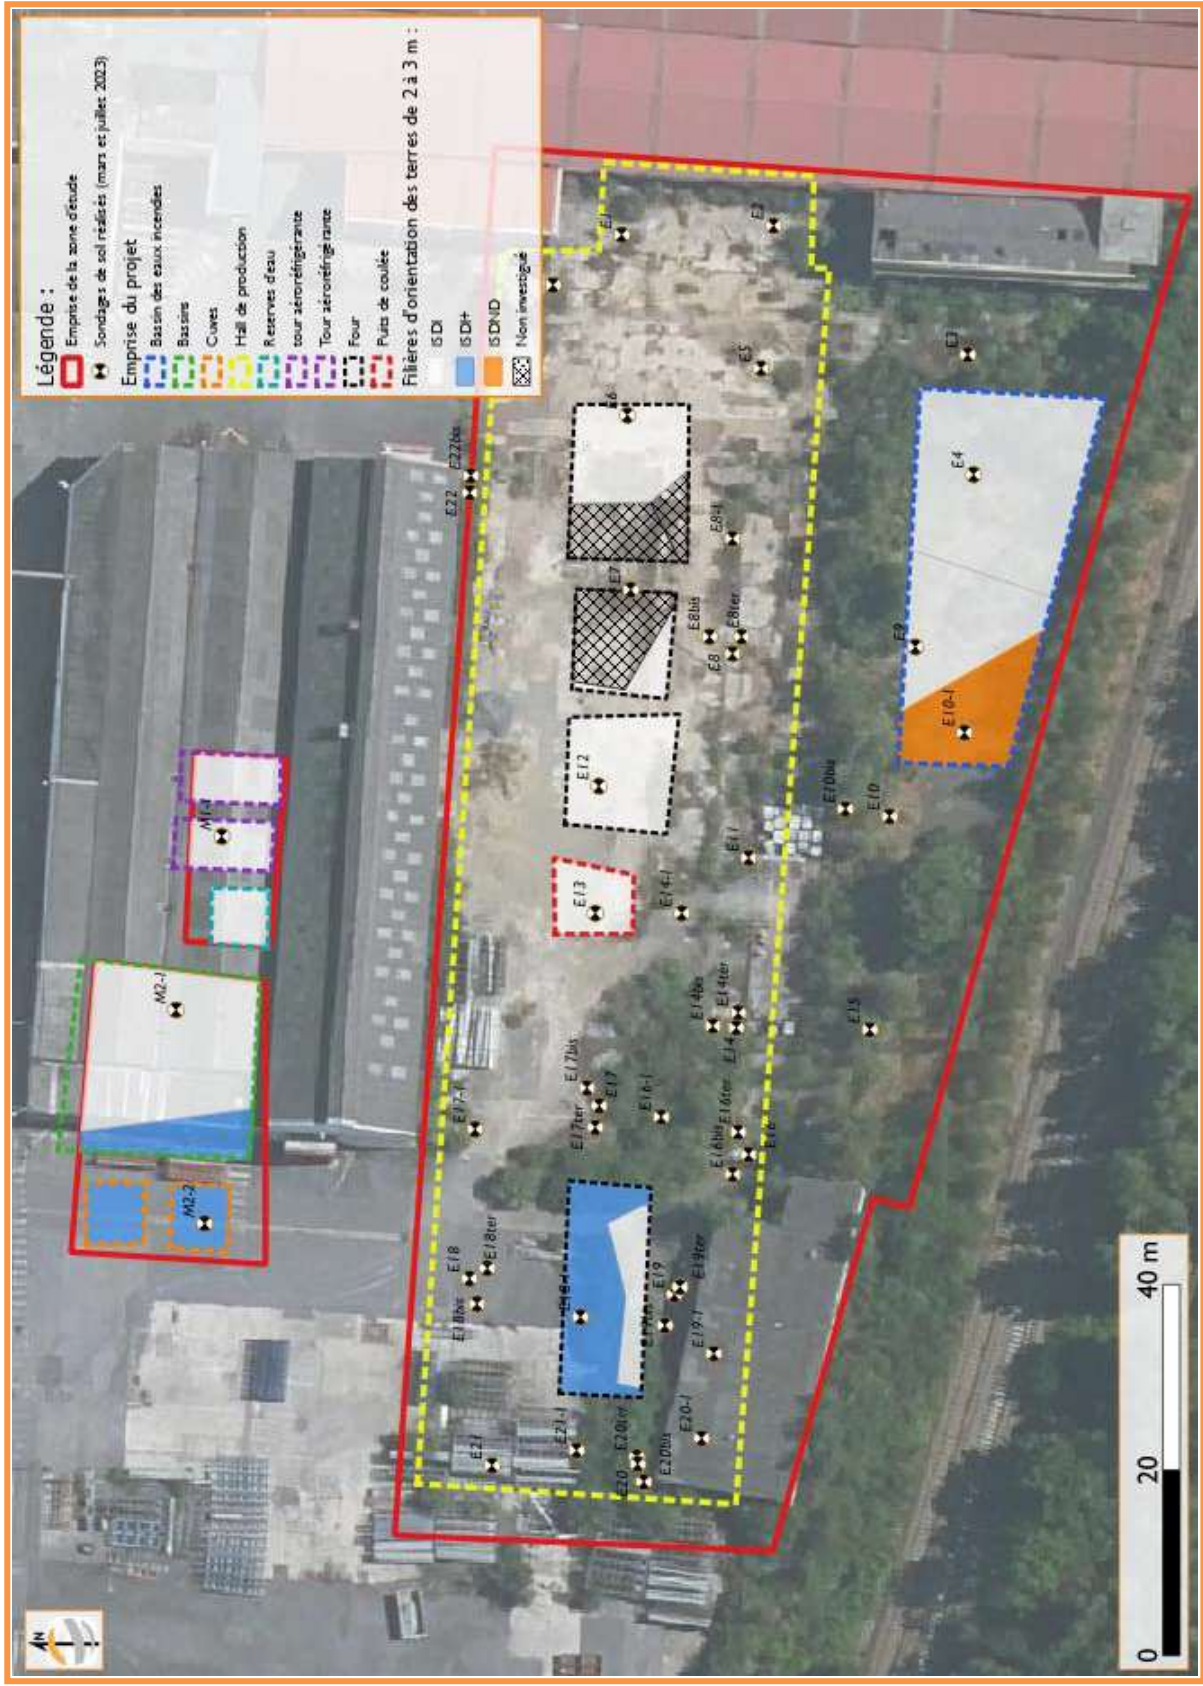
Plan de terrassement sur les terres à excaver entre 2 et 3 m
